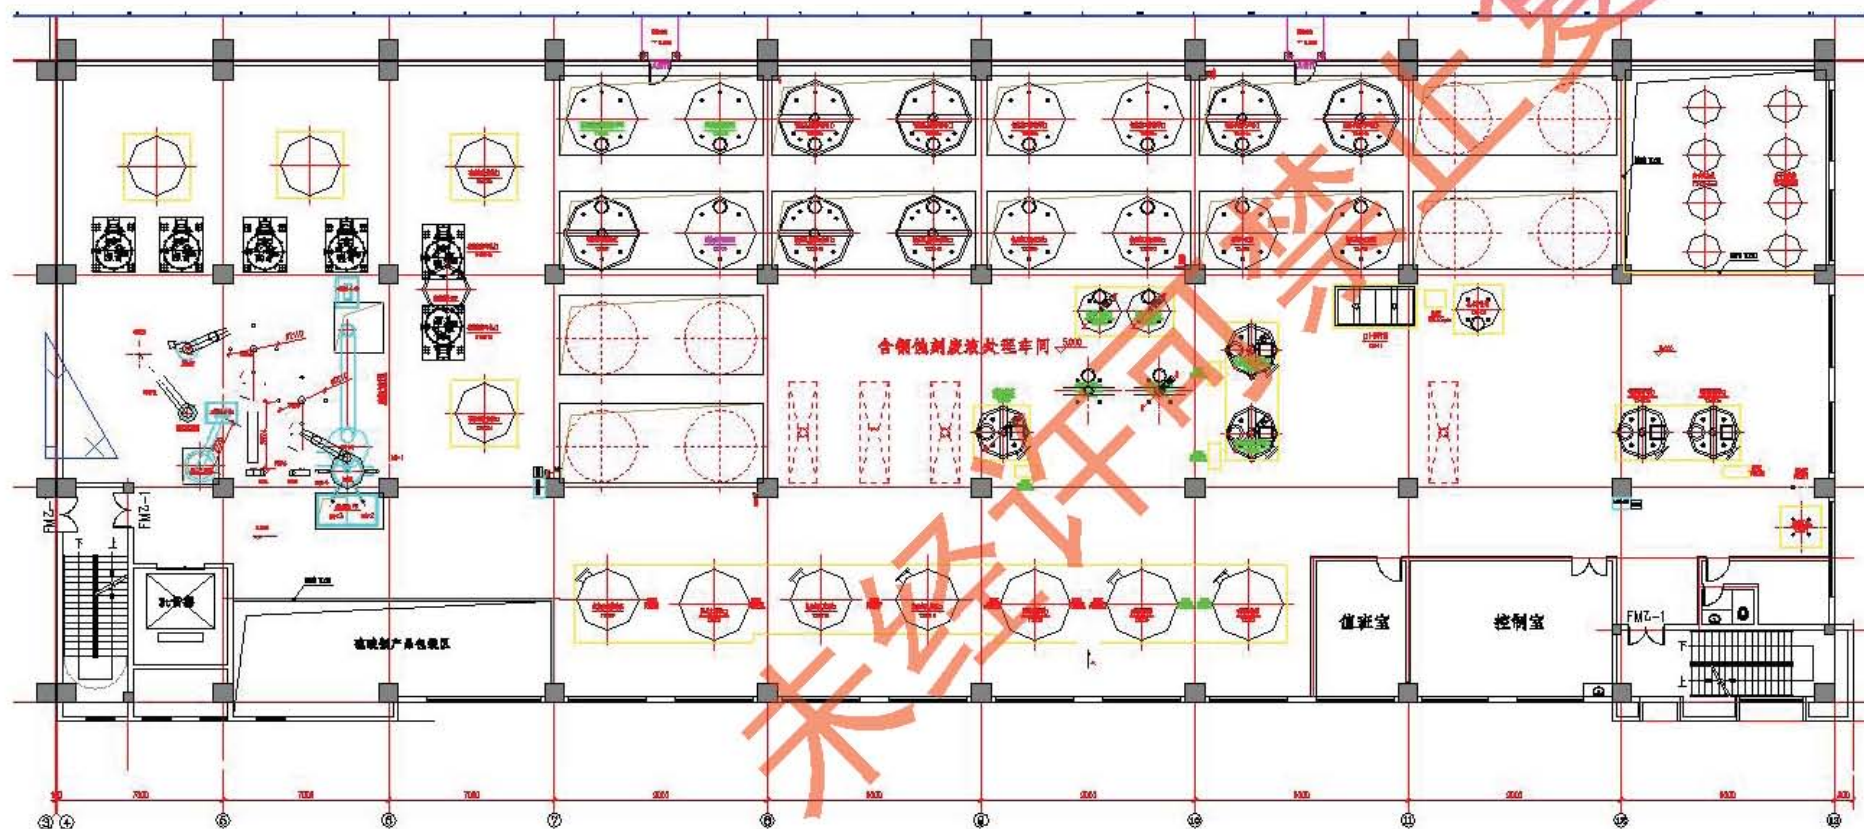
含铜蚀刻废液车间二层平面图
